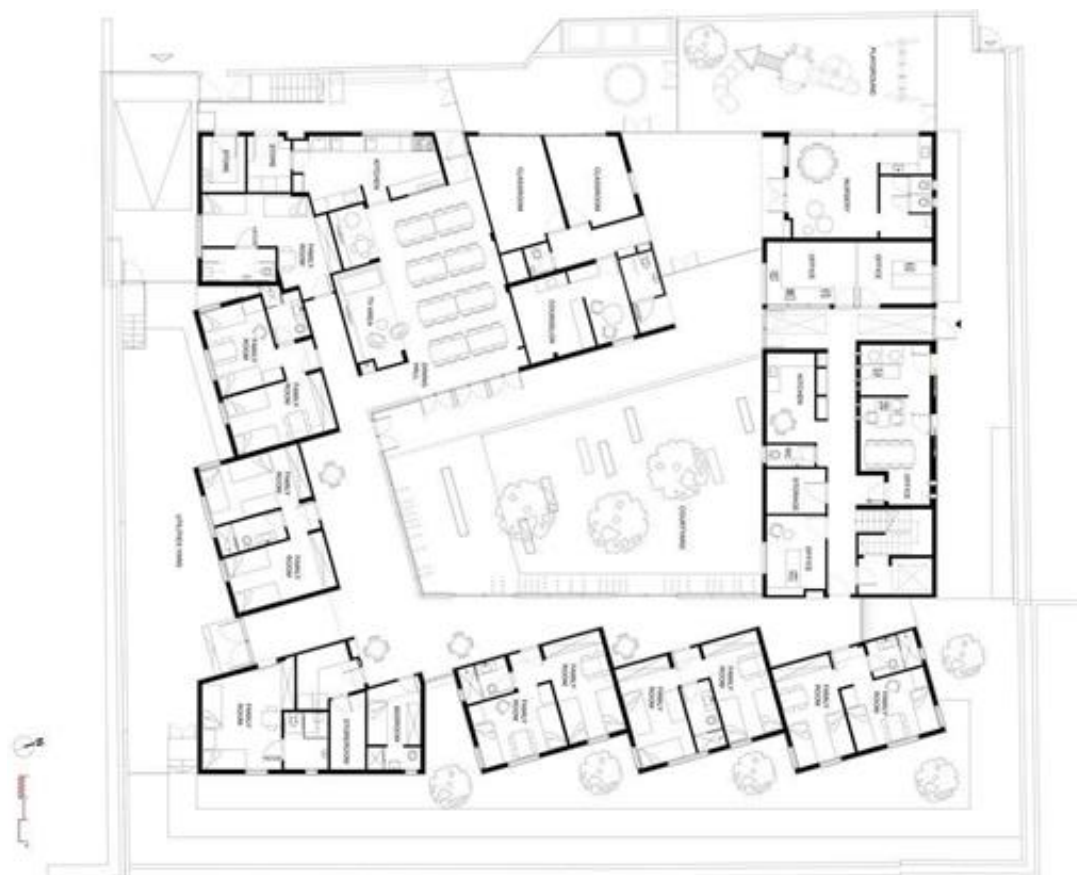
Planta pavimento térreo abrigo para vítimas de violência
